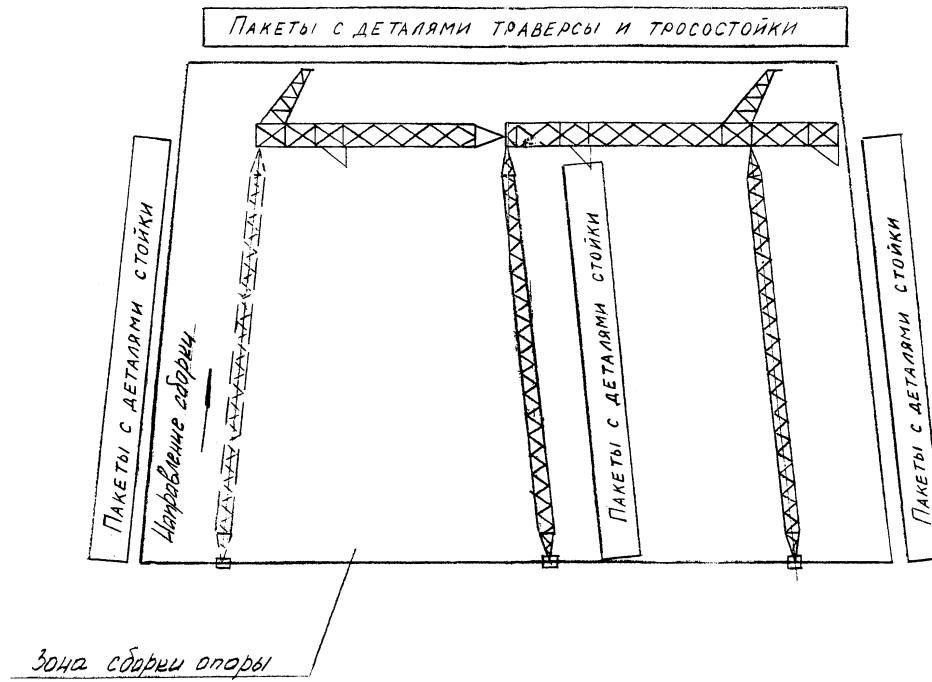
План глашадки для сборки промежуточно-угловых опор 174Б-20
